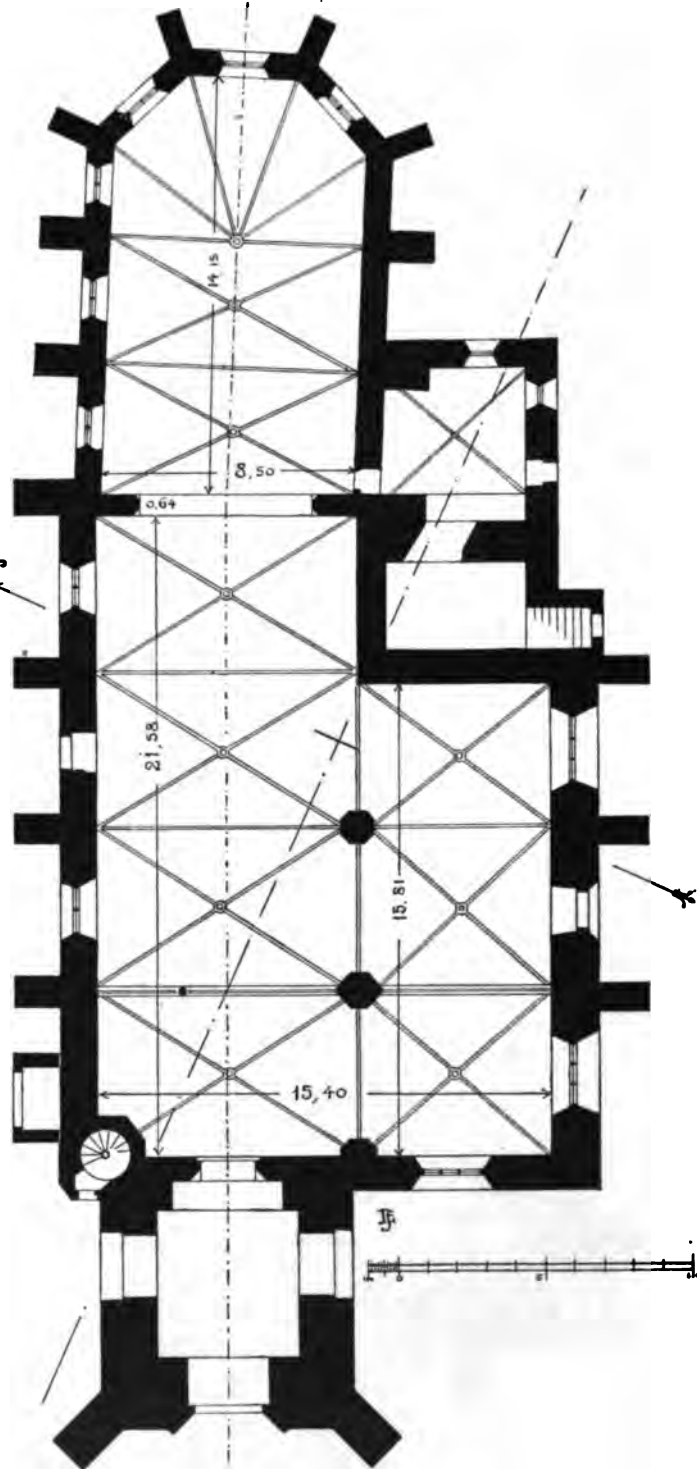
Eltville. Grundriss der Pfarrkirche.
